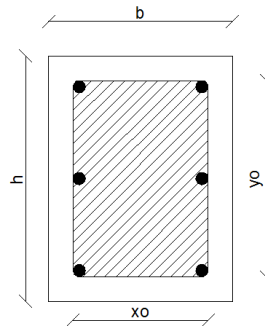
3 Sección transversal de una viga de hormigón armado con refuerzo a torsión.
